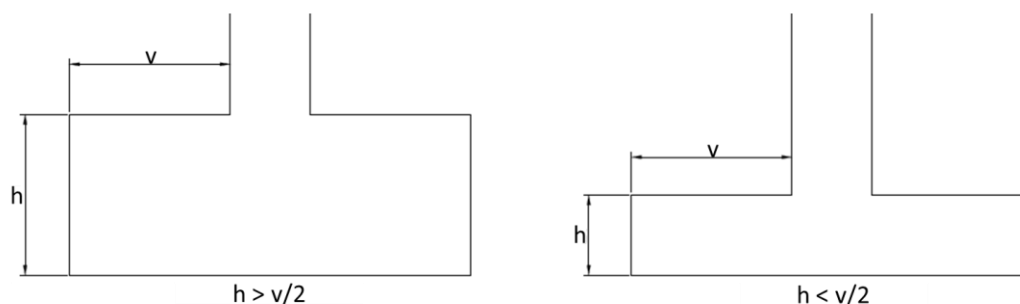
Zapatas rígidas y zapatas flexibles (fuente: elaboración propia)
